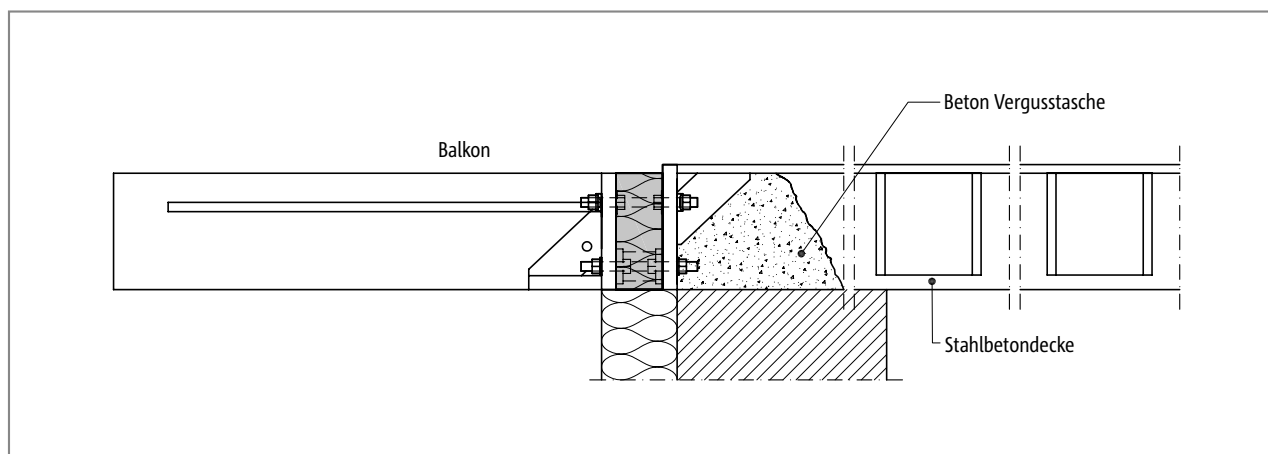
Schöck Isokorb® T Typ S: Nachträglicher Ortbetonbalkon frei auskragend; mit Zugband angeschlossen an bestehende Stahlbetondecke
